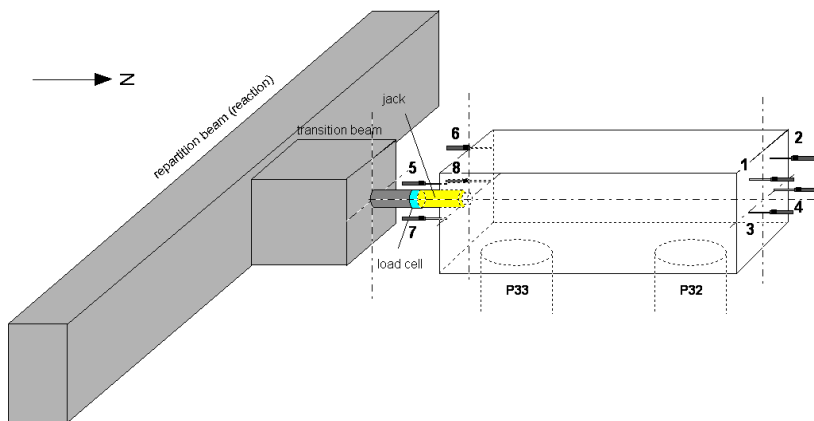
Схема испытания двух свай, спаренных ростверком, на горизонтальную нагрузку
